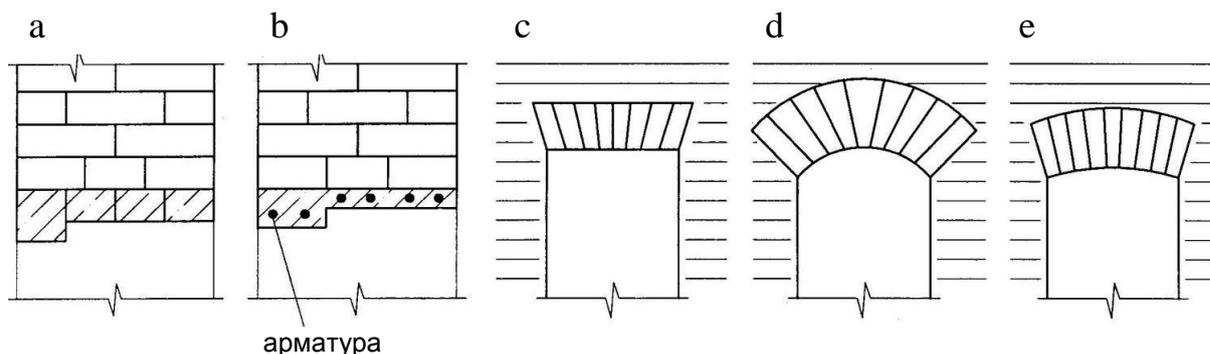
Виды перемычек в кирпичной кладке стен: а – железобетонная из сборных элементов; б – рядовая армированная; с – клинчатая; d – арочная; е – лучковая (https://perekos.net/default/fast_download/page_images.image_big.8d1170d92e0e1102.32312e6a7067.jpg)
